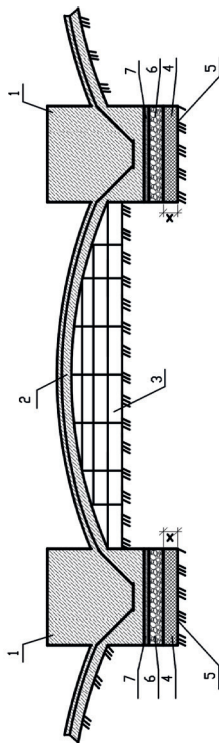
Новая конструкция фундамента с криволинейной формой контактной поверхности, где 1 – опорные железобетонные контуры; 2 – железобетонная оболочка; 3 – подололочечный массив из грунтоцементных блоков; 4 – демфирующая прокладка из пенополистирола; 5 – естественное грунтовое основание; 6 – щебеночная подготовка; 7 – бетонная подготовка из тощего бетона
